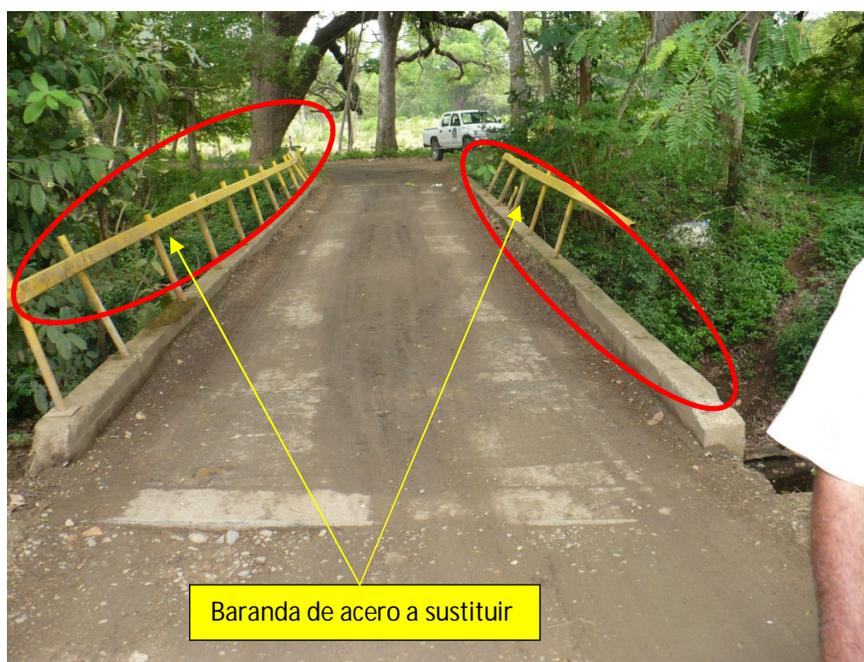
Barandas de acero en muy mal estado, faltan secciones.
